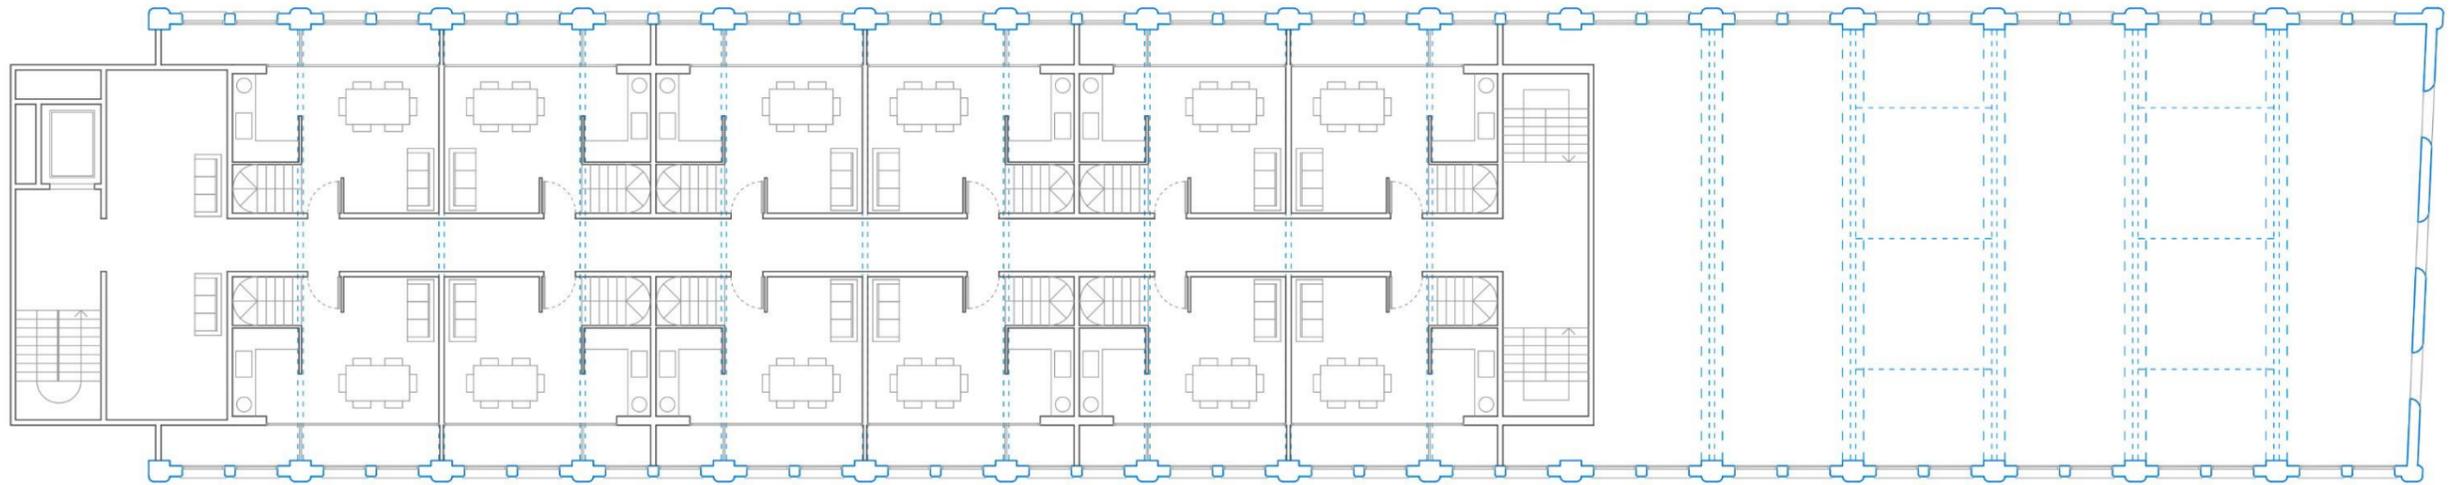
PLANO 1/200. Planta primera intervenció fàbrica Pere Font i Batallé.
